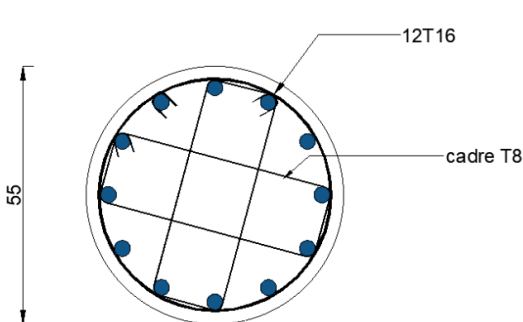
schéma de ferrailage des poteaux circulaires de 2^{me} et 3^{ème}
